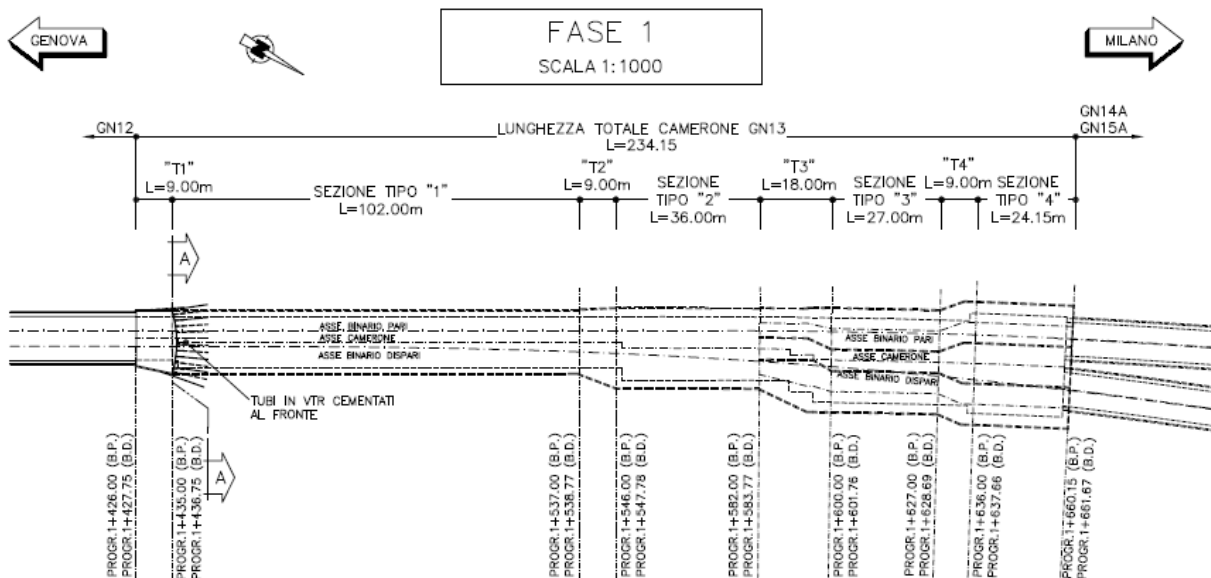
Sezioni tipo Camerone previste da Progetto Esecutivo
